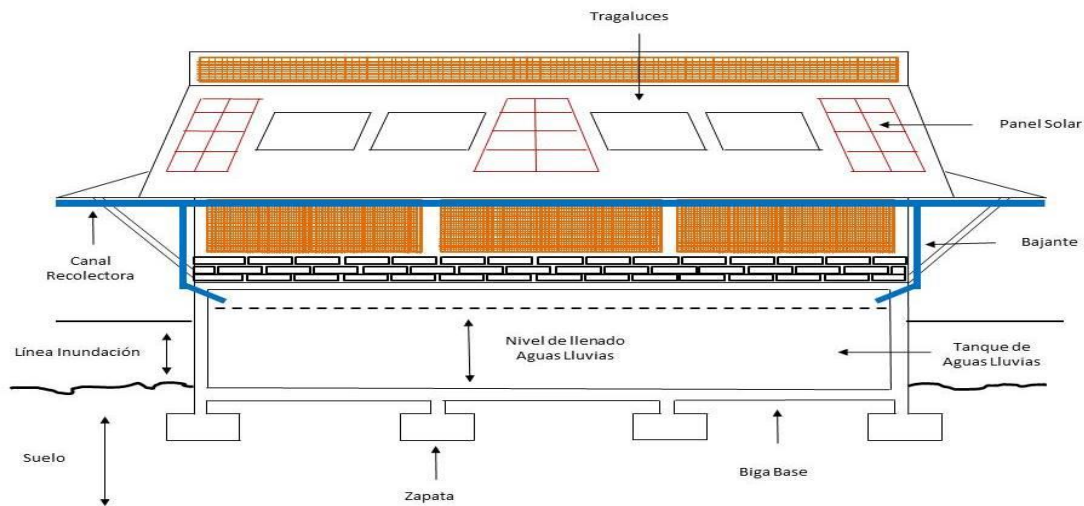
Estructura Red de Acueducto Cabañas Yewae, Fuente: Elaboración Propia
